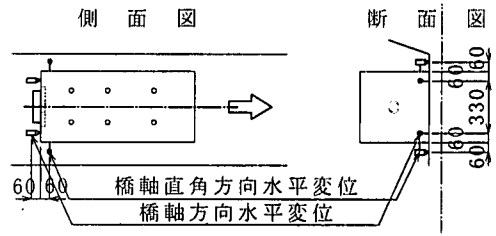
コンクリート定着体変位測定位置 (寸法単位: mm)
